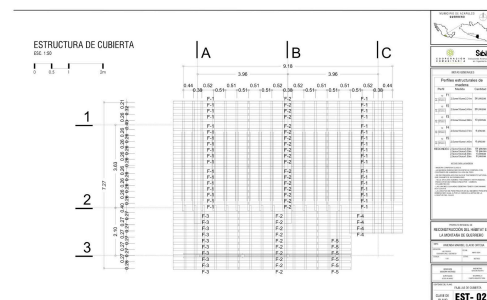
Estructura de cubierta: fajillas (EST-02)
